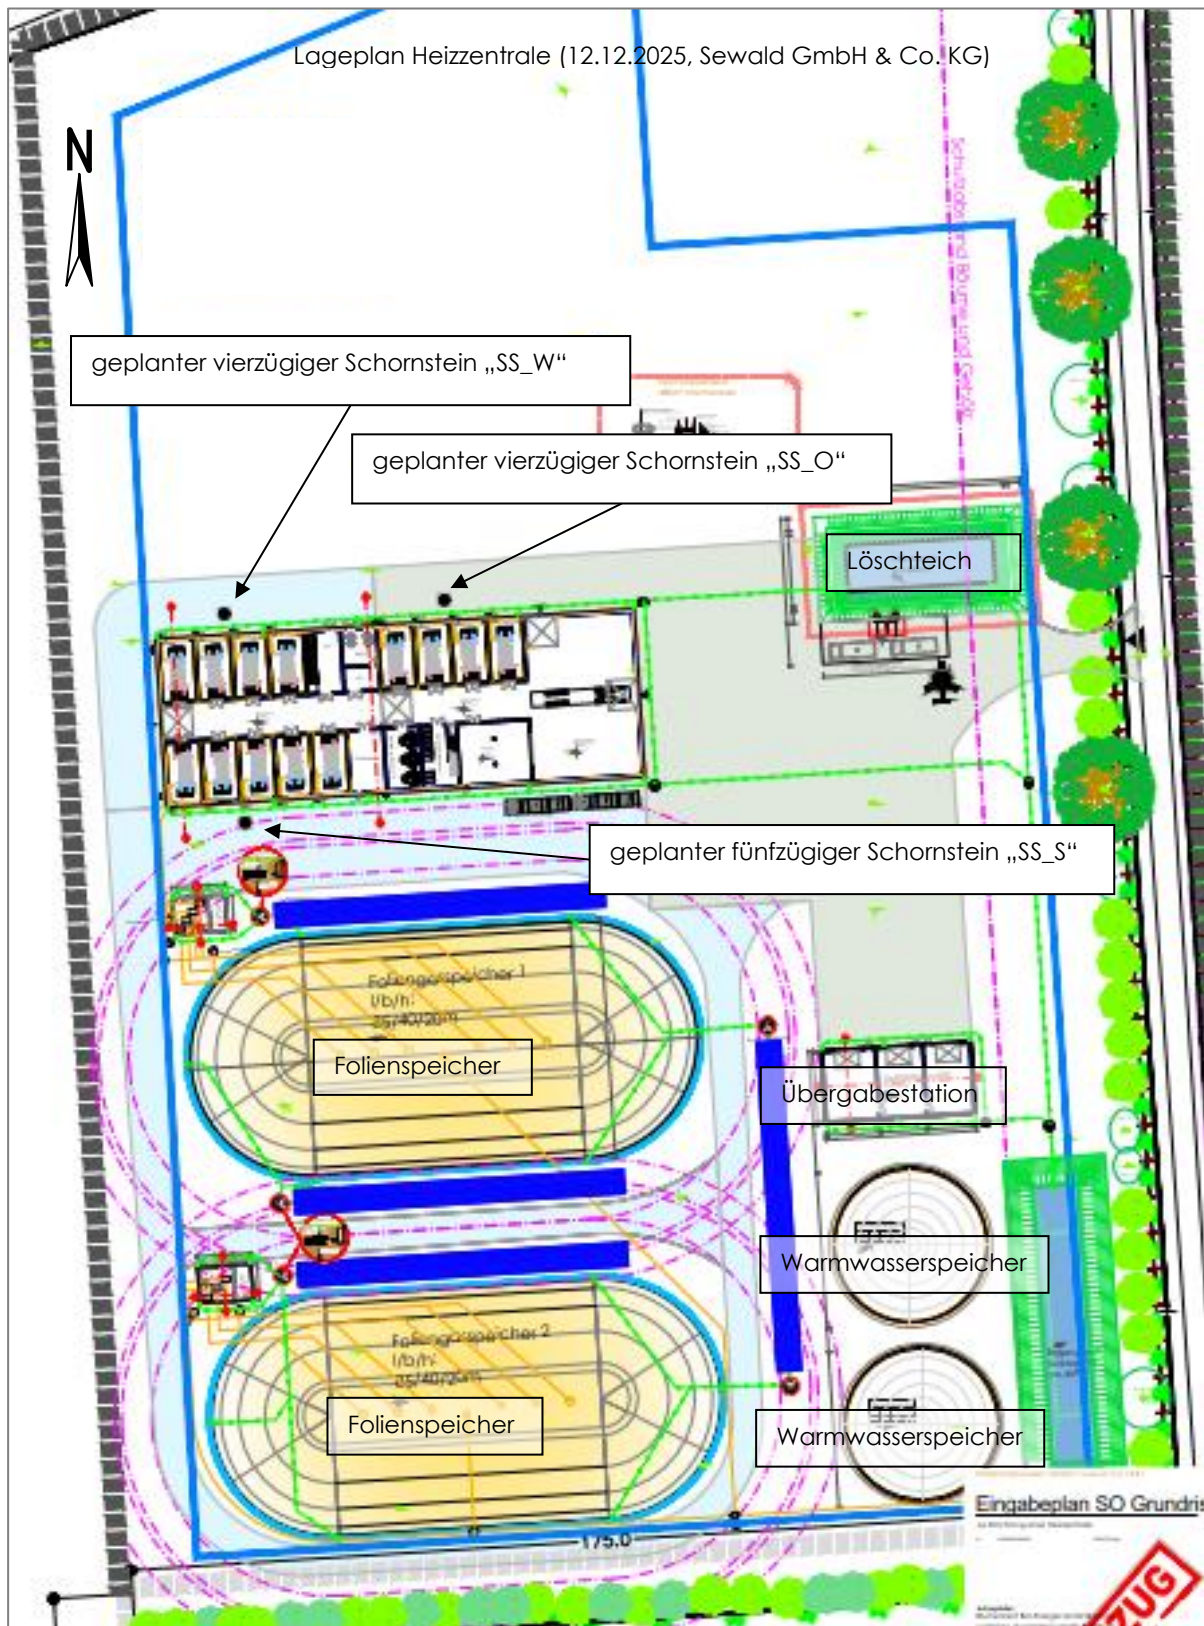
Auszug Lageplan, Lage der drei geplanten Schornsteine
